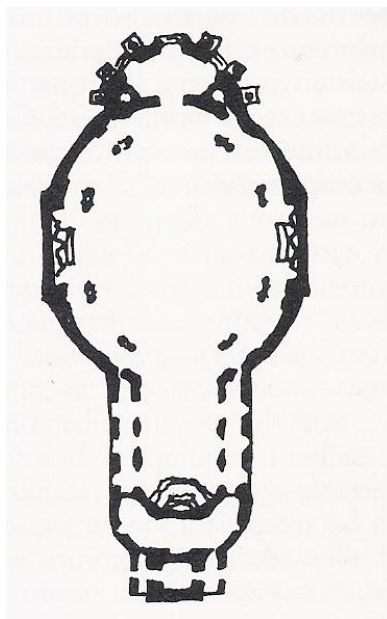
Santuário de Wies na Bavária, planta de Zimmermann.
